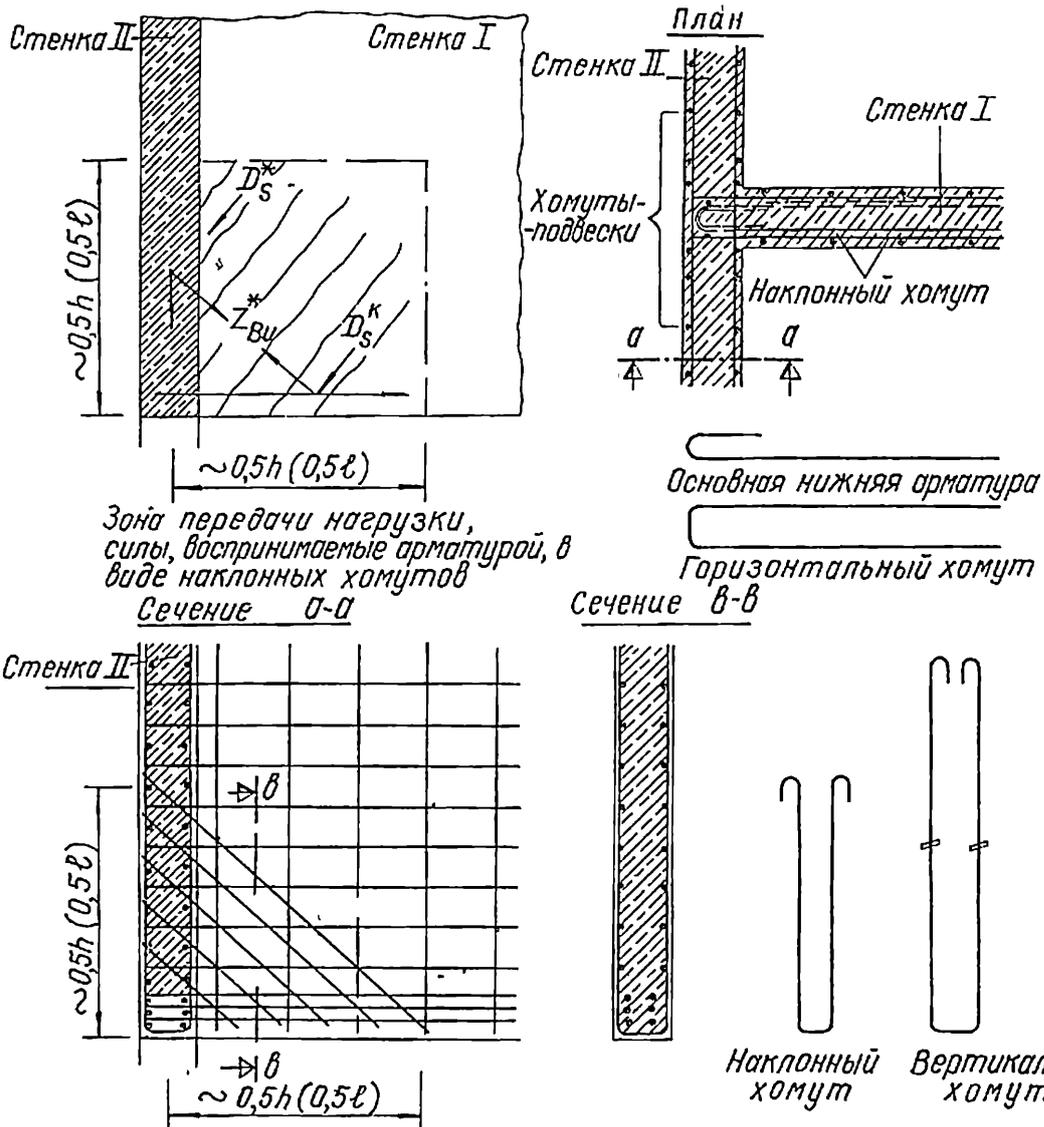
15. Армирование зоны сопряжения балок-стенок, приведенных на рис.2.5 - 14 при значительных усилиях
